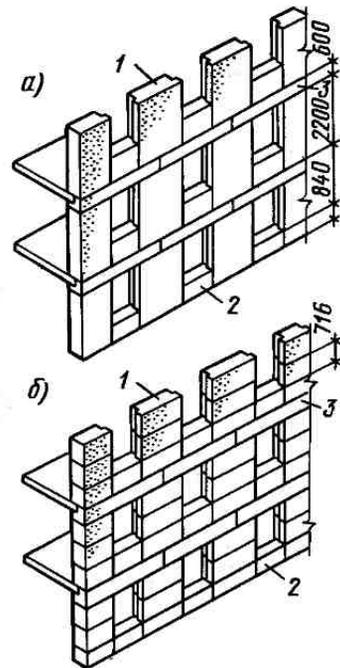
Схемы разрезки стен крупноблочных зданий:
